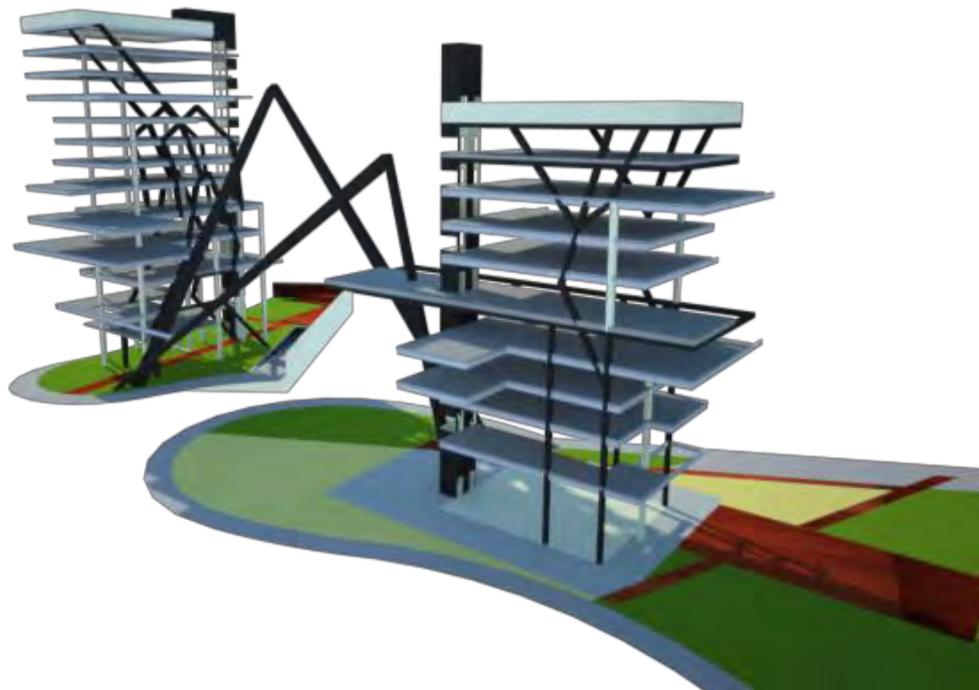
Estruturas, lajes e caixa de elevador. As estruturas estão engastadas nas caixas, bem como as lajes.
